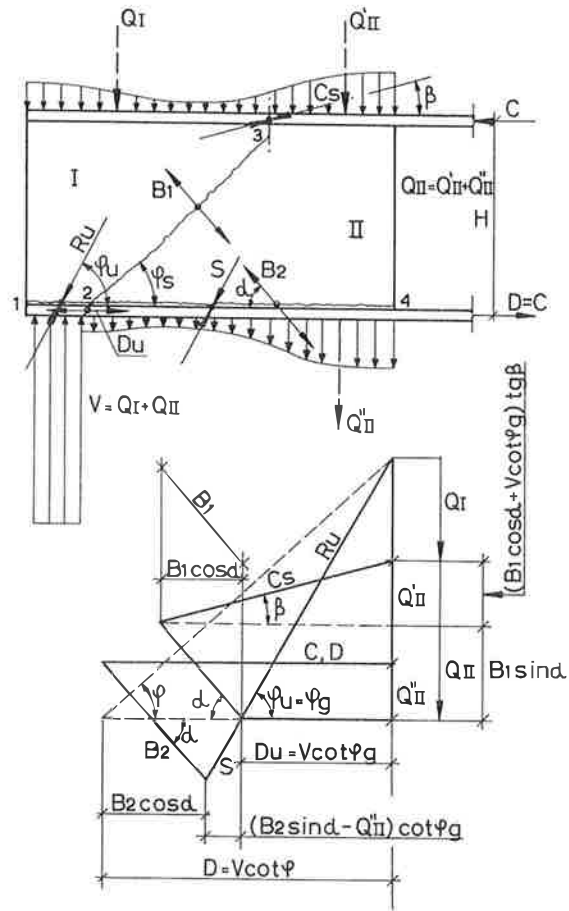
Brottlinjer och jämviktstillstånd i en väggskiva med byglar och väl förankrad armering i bjälklaget. • Yield lines and conditions of equilibrium for a wall provided with stirrups and well-anchored reinforcement in the lower floor slab.
